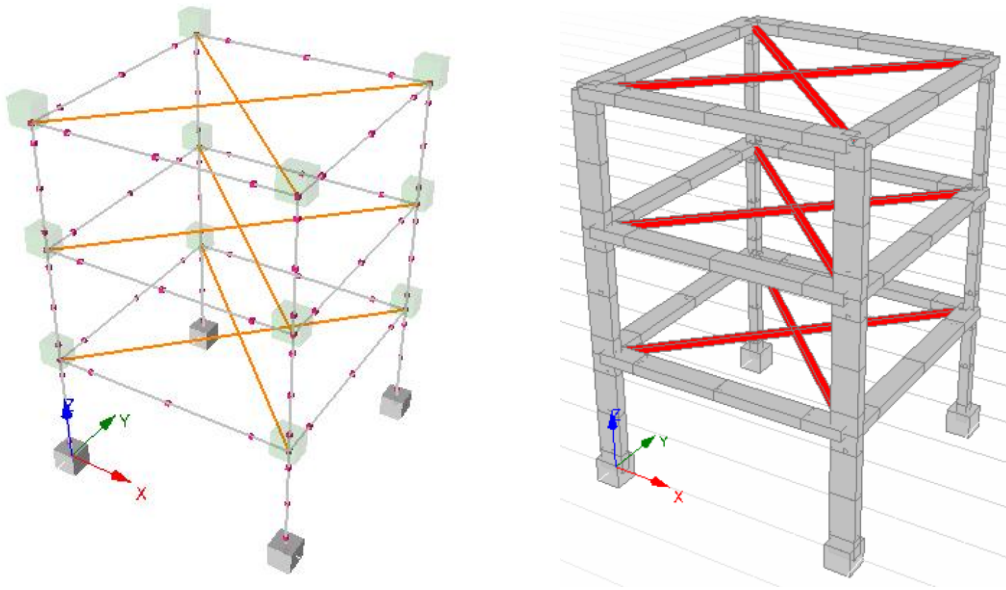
Suddivisione della struttura in esame in elementi finiti.
